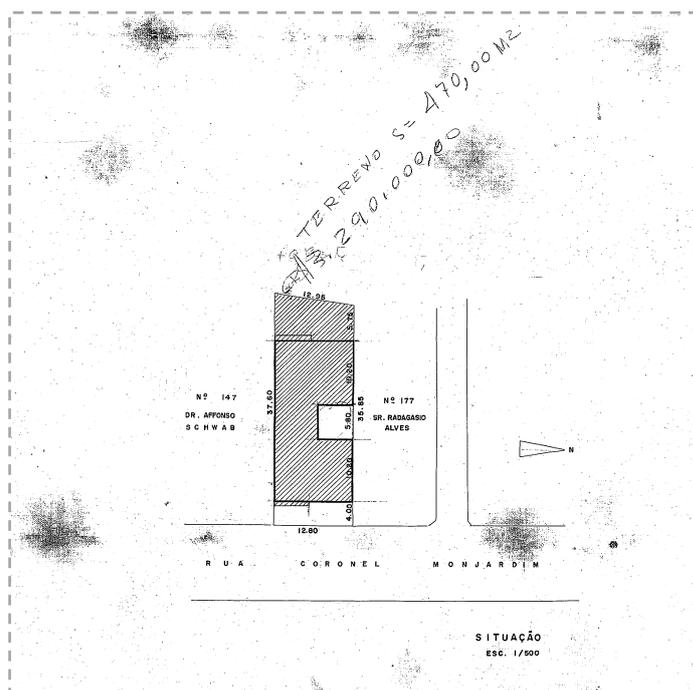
Detalhe Planta de implantação do Ed. Barcellos.
